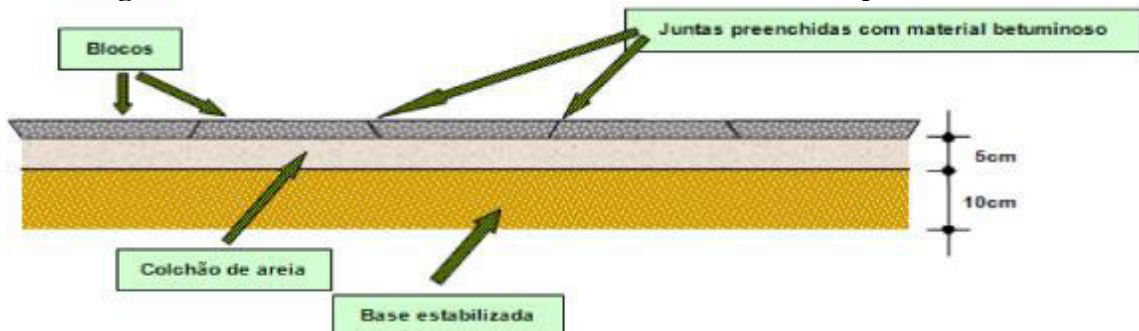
Pavimento de ciclovia em placas de concreto pré-fabricado.
